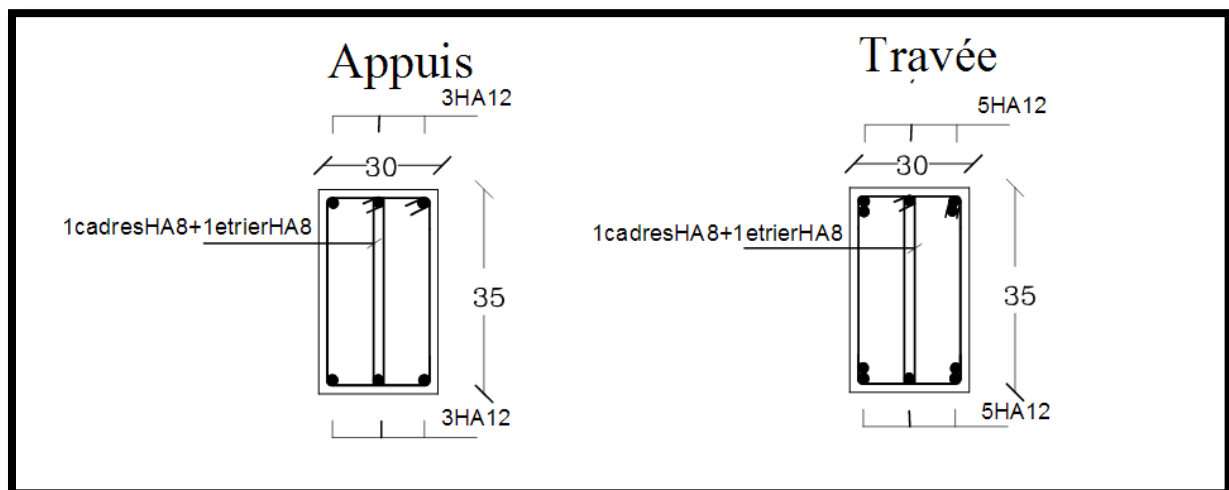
Schéma de ferrailage de la poutre palière.
